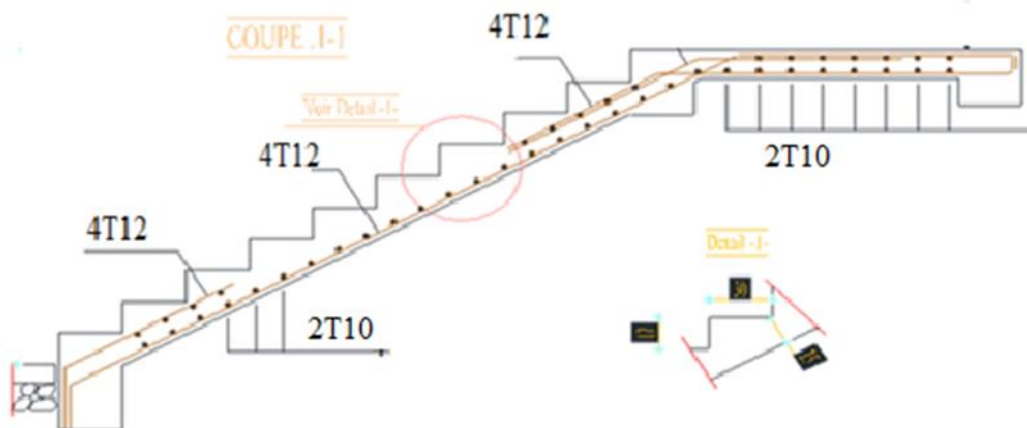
IV.14 Schéma de ferrailage d'escalier (type 1).
